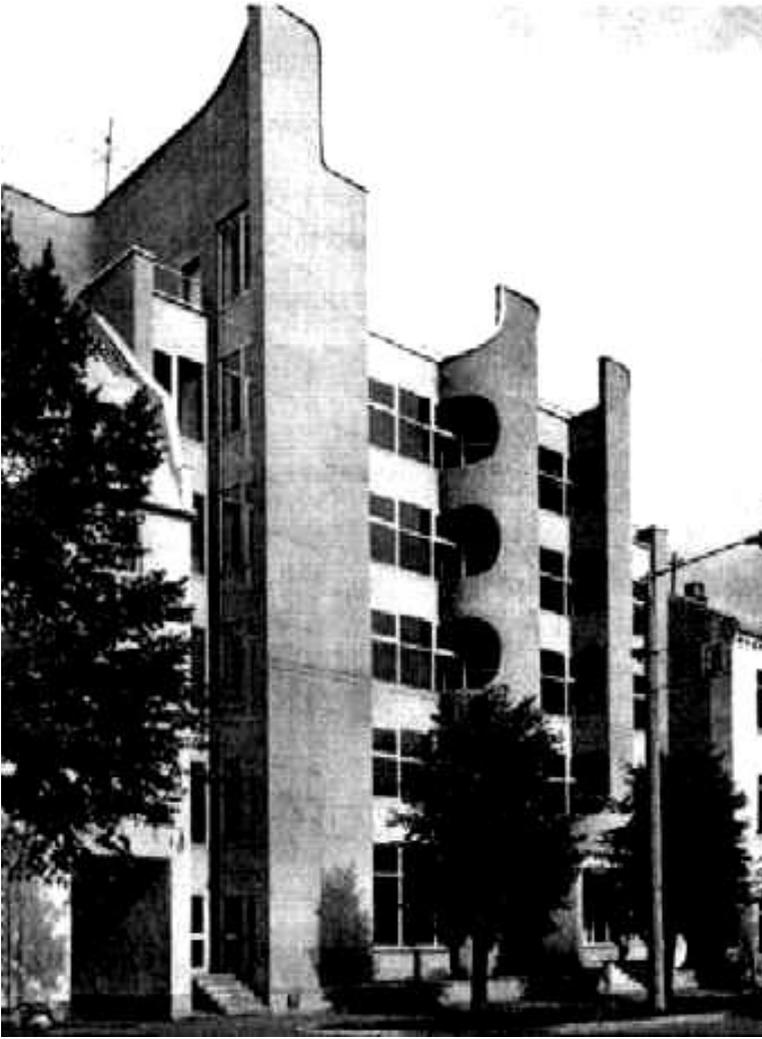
Размещение лифтовой шахты вплотную к наружной стене в общественном здании
